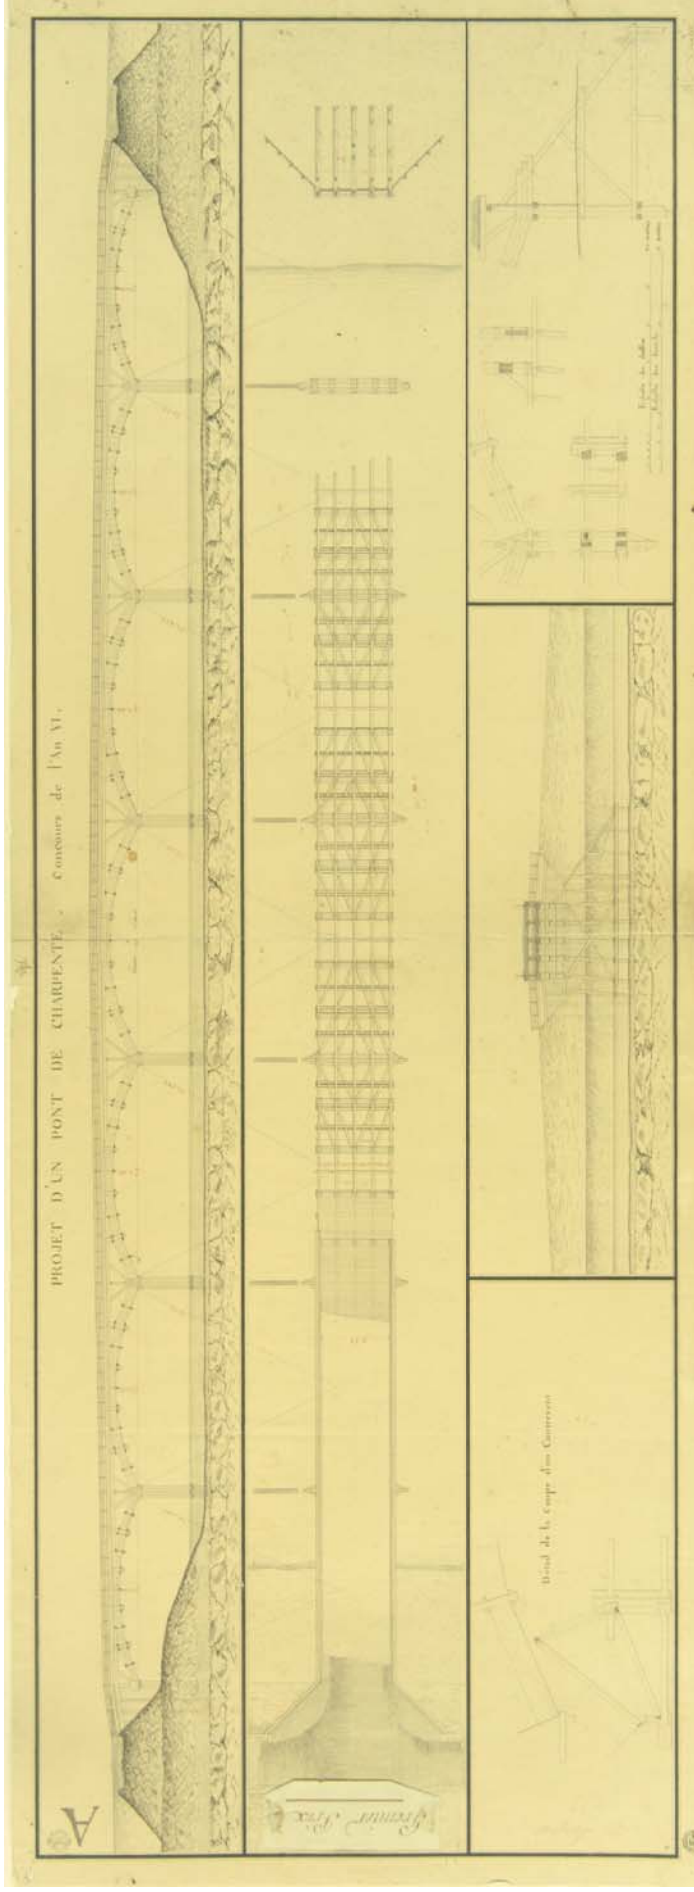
DG 468 – Benjamin Lenglier. Concours de l'An VI. Projet d'un pont en charpente. Elevation, plan, coupe et details. Première Prix. 1799
